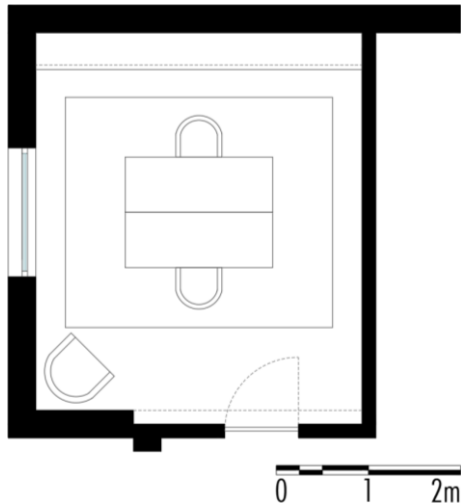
Planta de estudo de *layout* do escritório 1 (Fonte: Autora, 2022)
